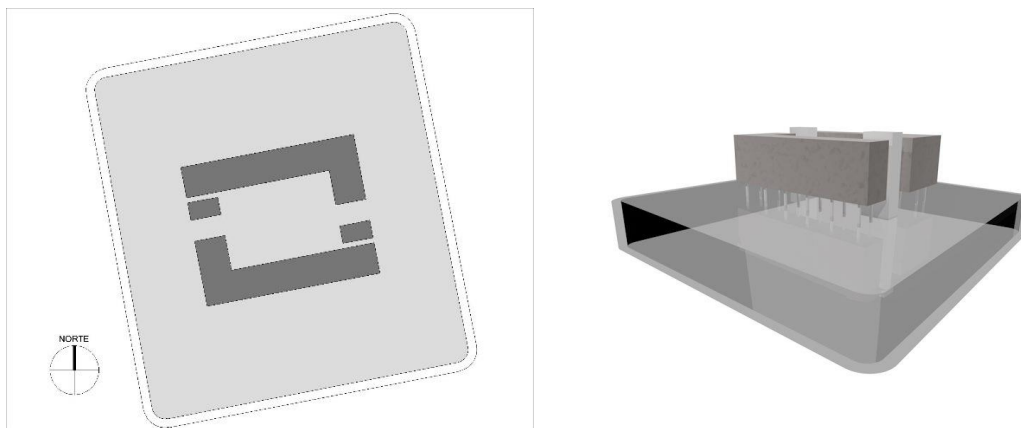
Implantación en claustro ortogonal a norte. Planta - isométrico. Fuente: elaboración propia.
